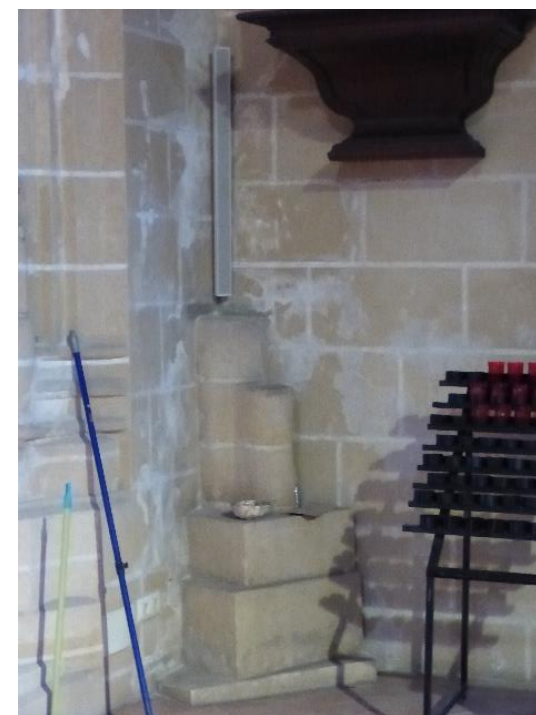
Restos de pilar anillado en muro del evangelio. San Mateo. Jerez.
